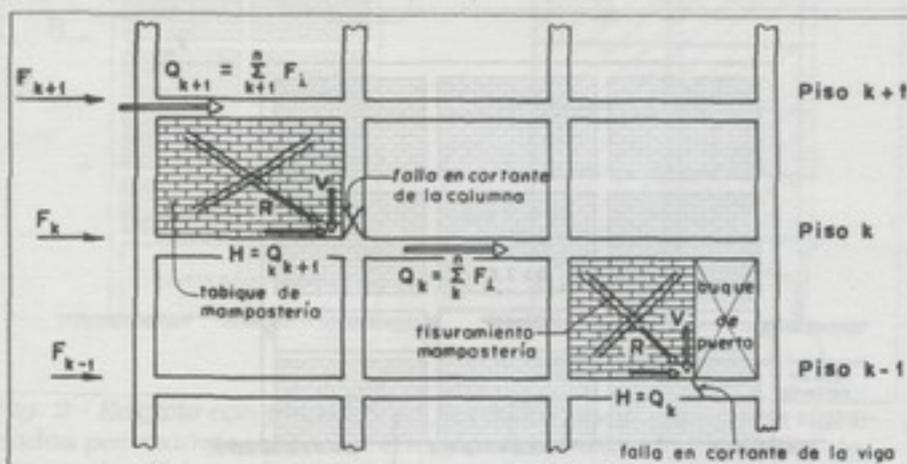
Falla en cortante de columnas y vigas debido a la interacción de los tabiques de mampostería. El cortante es transmitido al piso inferior como fuerza diagonal. La componente horizontal puede conducir a la falla de la columna, la componente vertical causa la falla de la viga.
